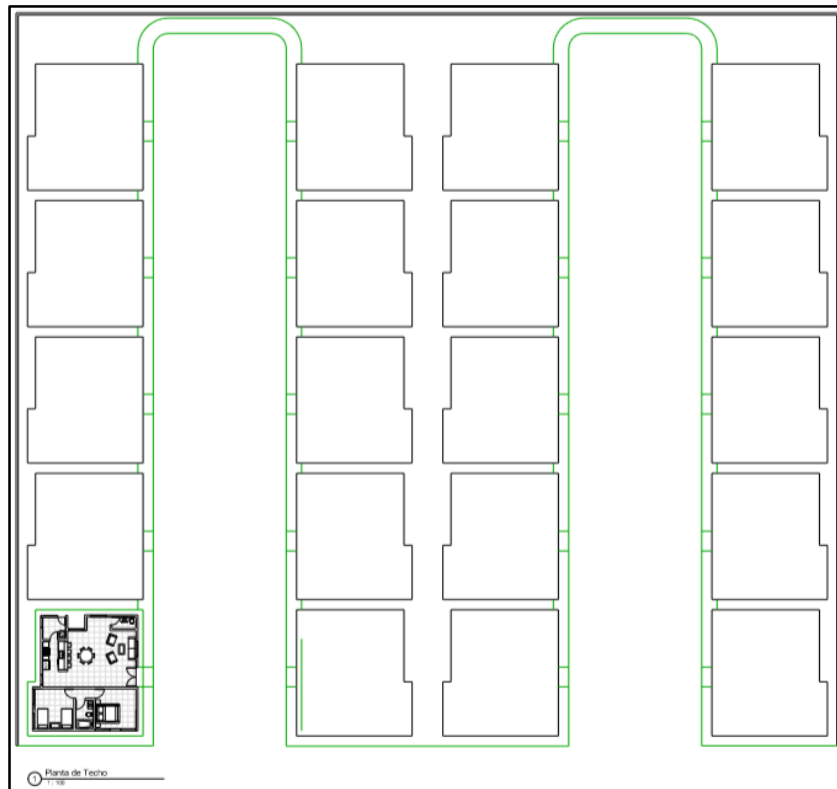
Vista en planta de la superposición de la propuesta de ubicación de viviendas sociales.
